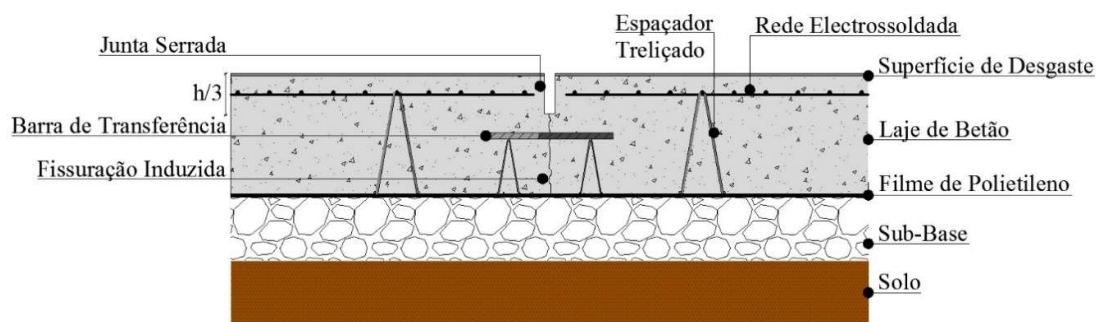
Esquema ilustrativo de um pavimento de betão com malha eletrossoldada (Adaptado de Passos, M., 2011)
